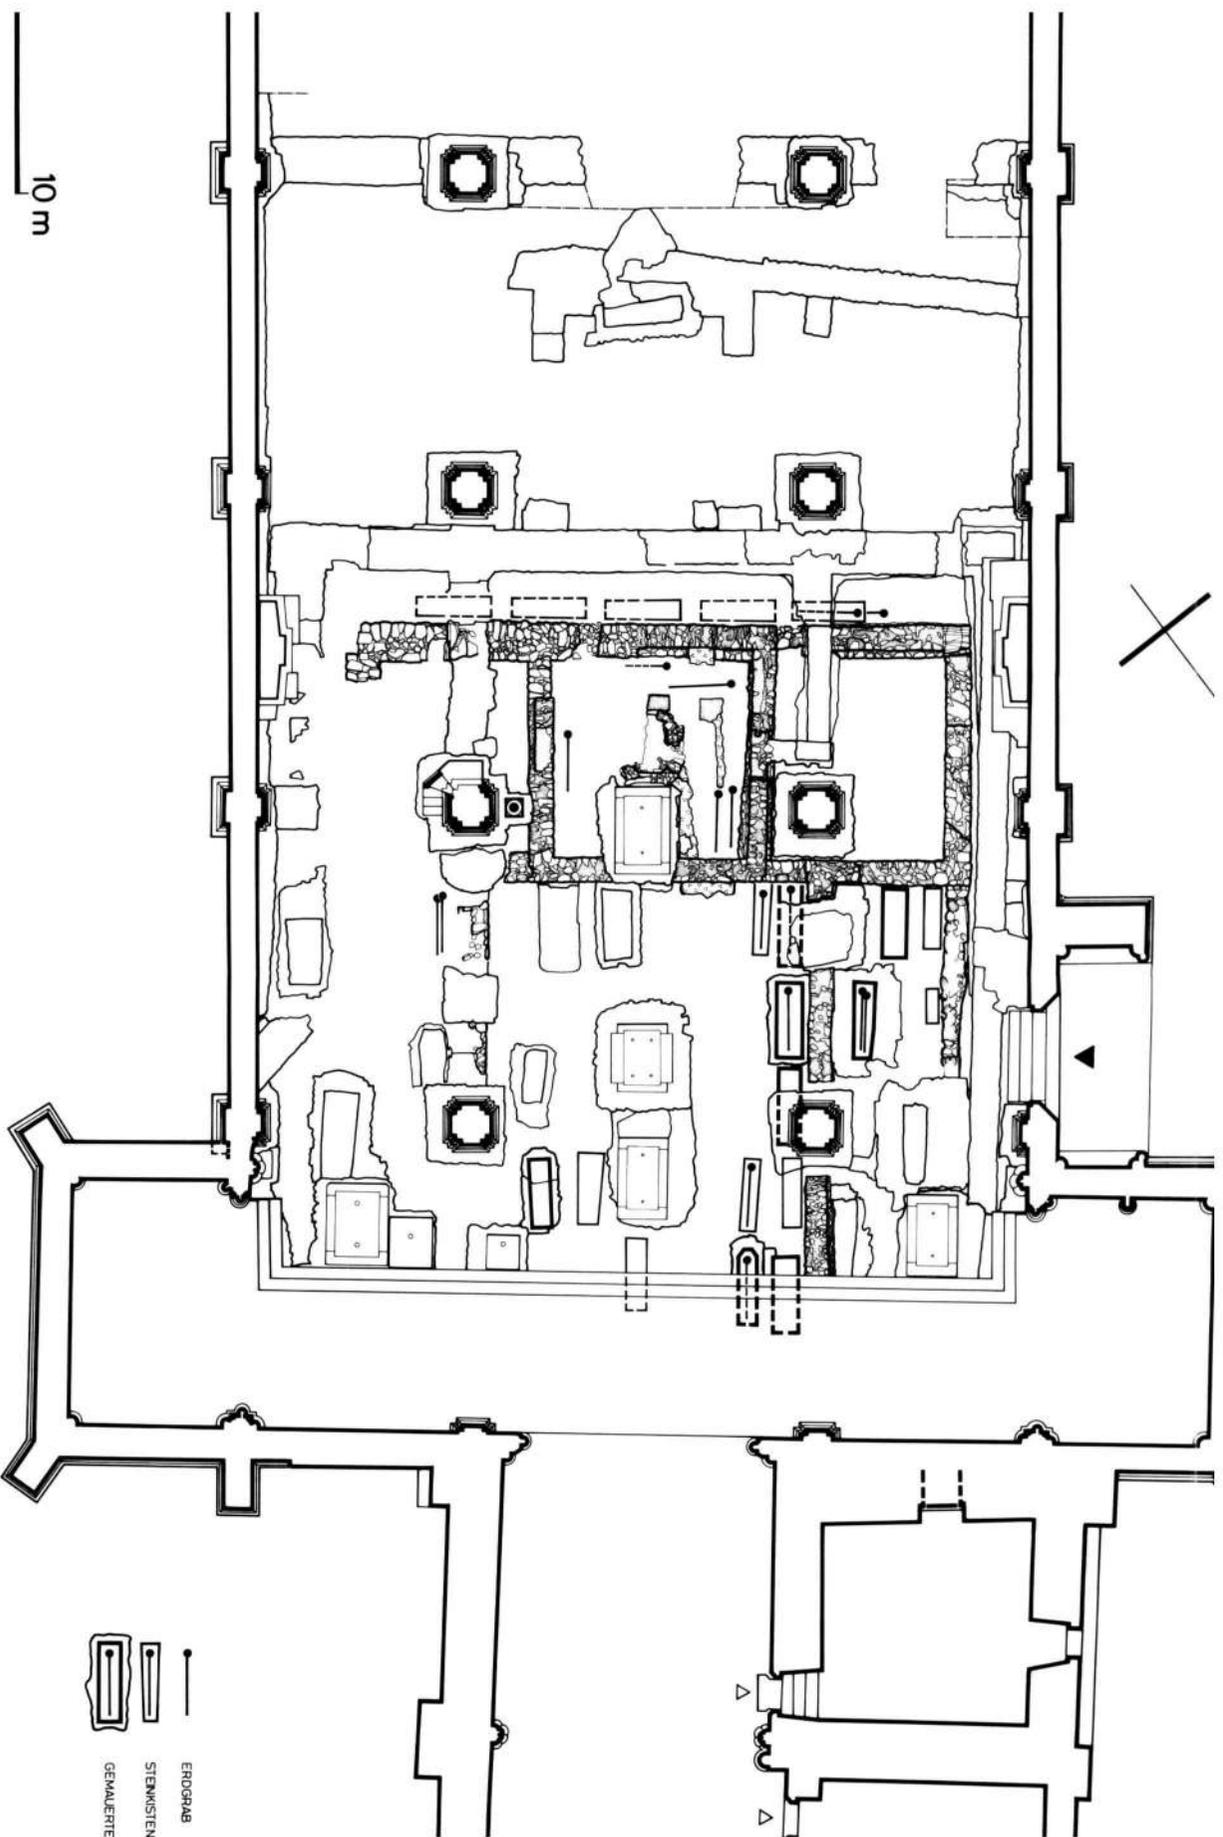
Anlage I; Baptisterium: archäologischer Grundriss mit rekonstruiertem
